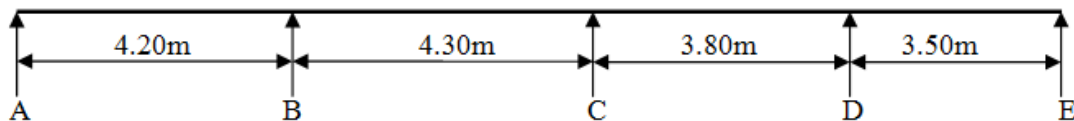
schéma statique de la poutre sur 5 appuis
